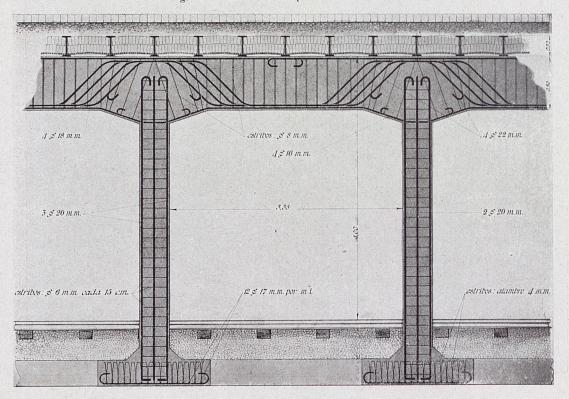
Túnel con techo plano.-Sección longitudinal,
